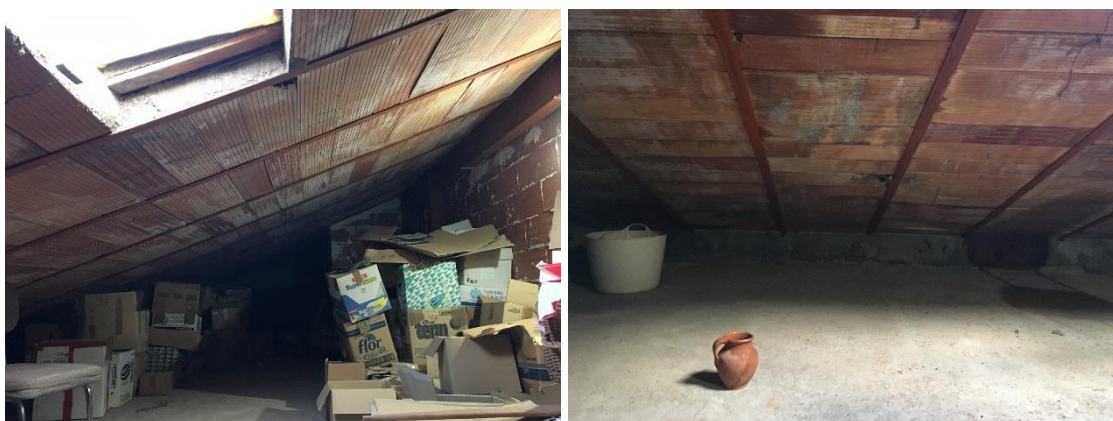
Planta bajocubierta. Almacenes bajo los faldones de la cubierta.
